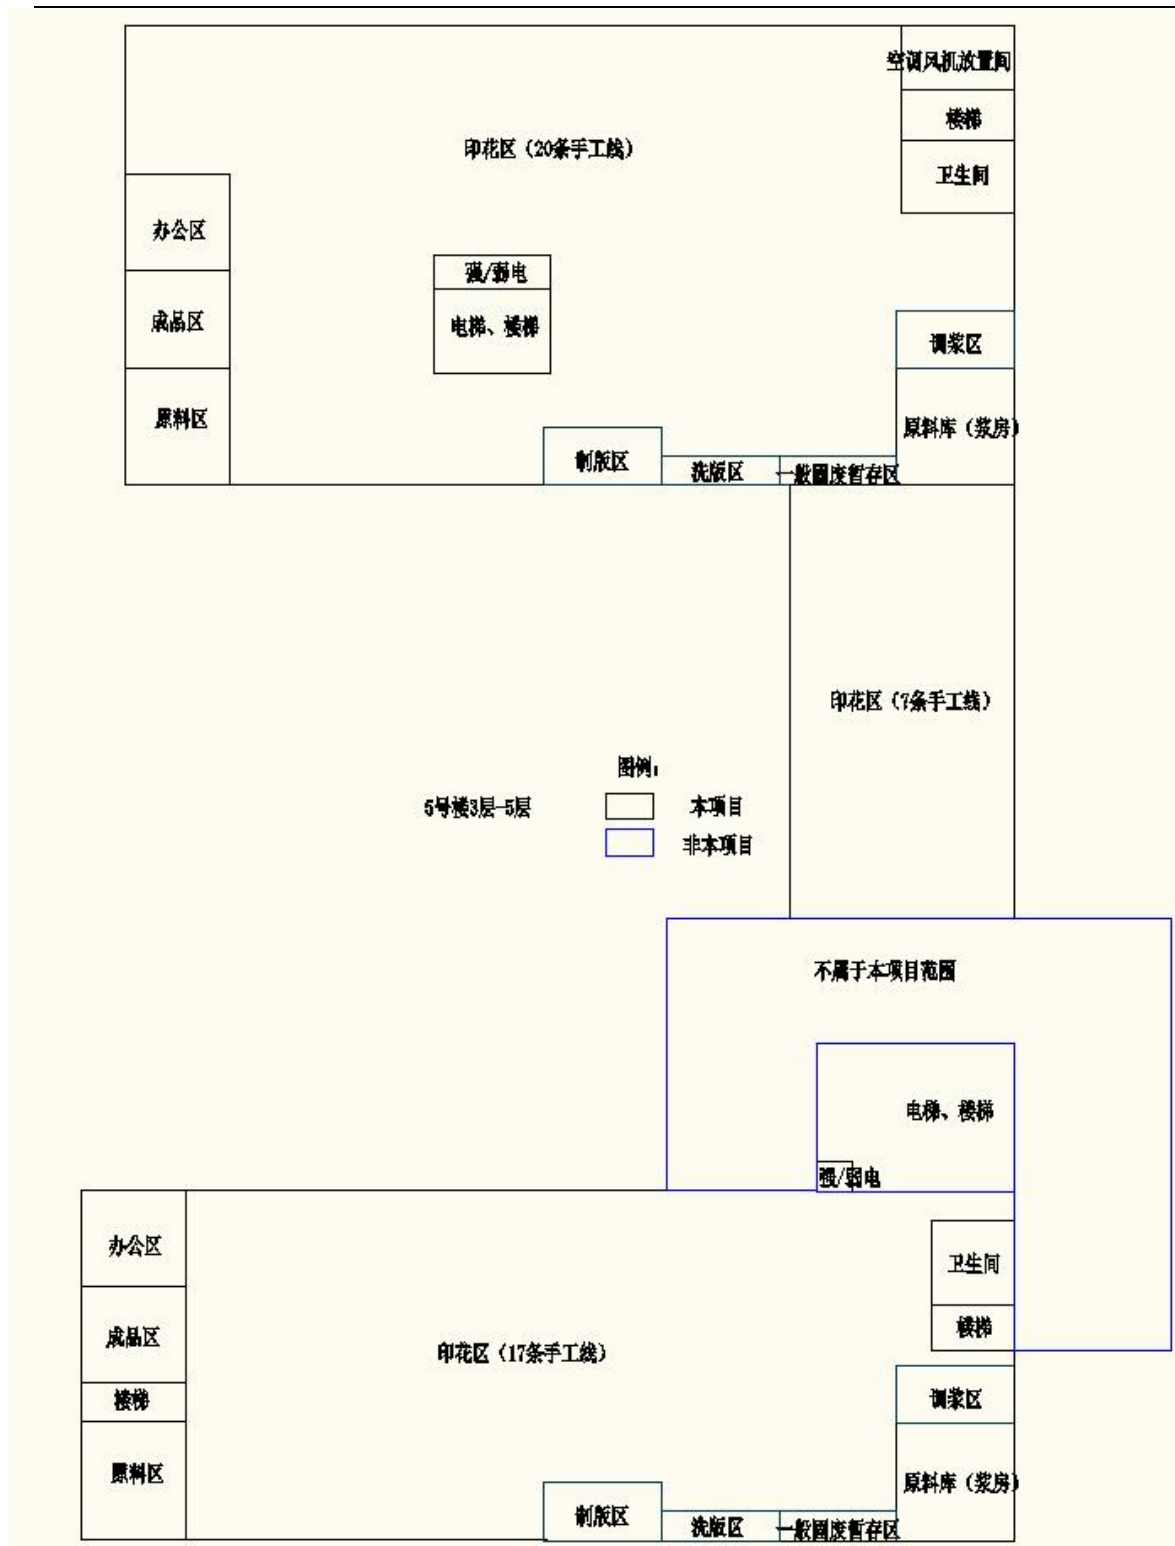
5 号楼 3 层-5 层车间平面布置图
